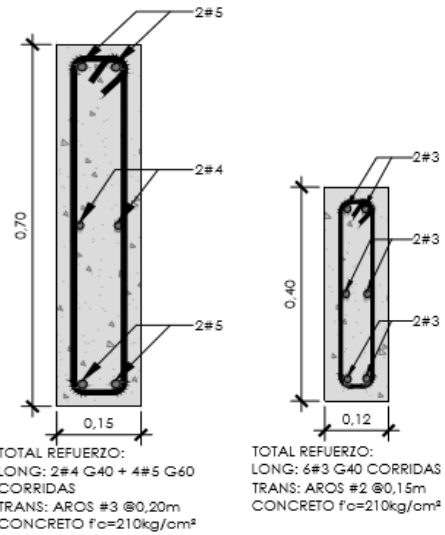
Detalle de viga VH70C a la izquierda y VH40D a la derecha. (Lámina S 09 de planos estructurales del edificio ISLHA)
